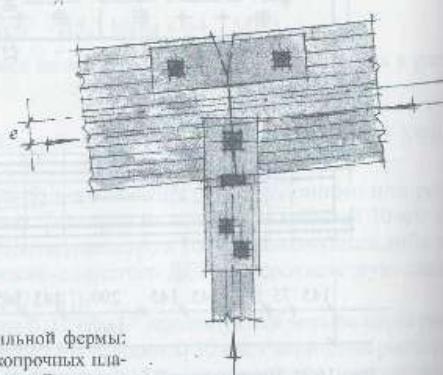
Узлы верхнего пояса безметаллической фермы:
